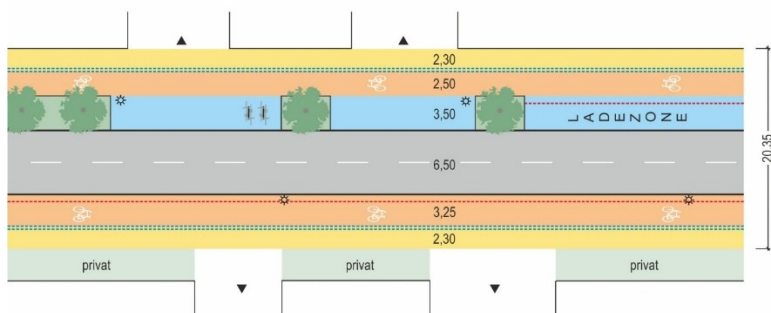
Exemplarische Lageplangestaltung für eine Gewerbenebenstraße (US 4.1)
